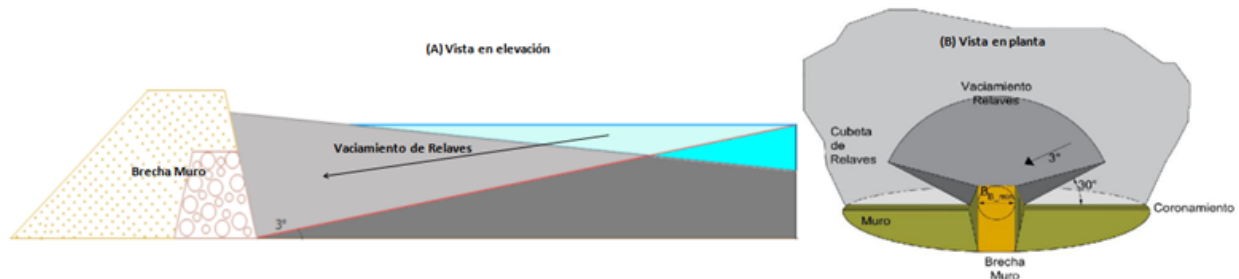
Geometría tipo considerada para modelo de vertimiento, vistas en planta y elevación.
